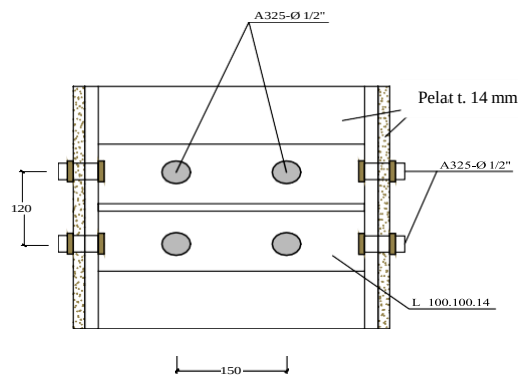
Tampak atas sambungan balok arah x dengan kolom
